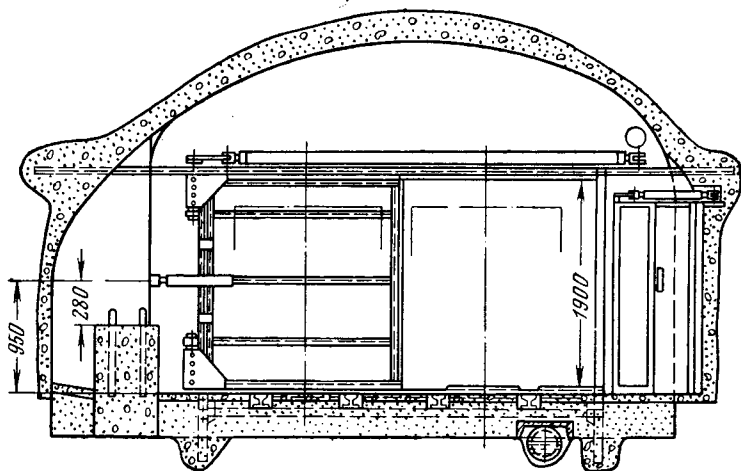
Вентиляционная дверь на двухпутевую выработку
